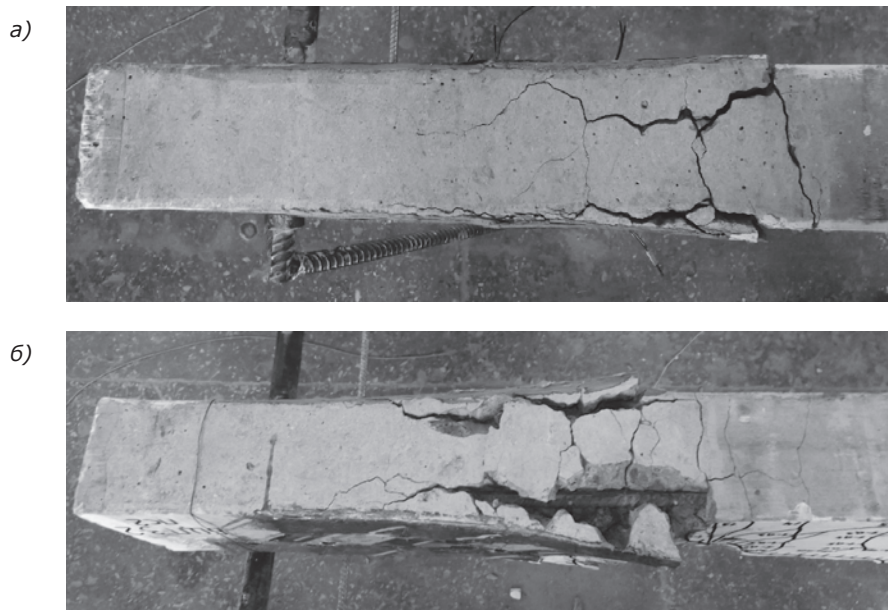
Руйнування бетону на нижній грані підсиленої балки при навантаженні:
